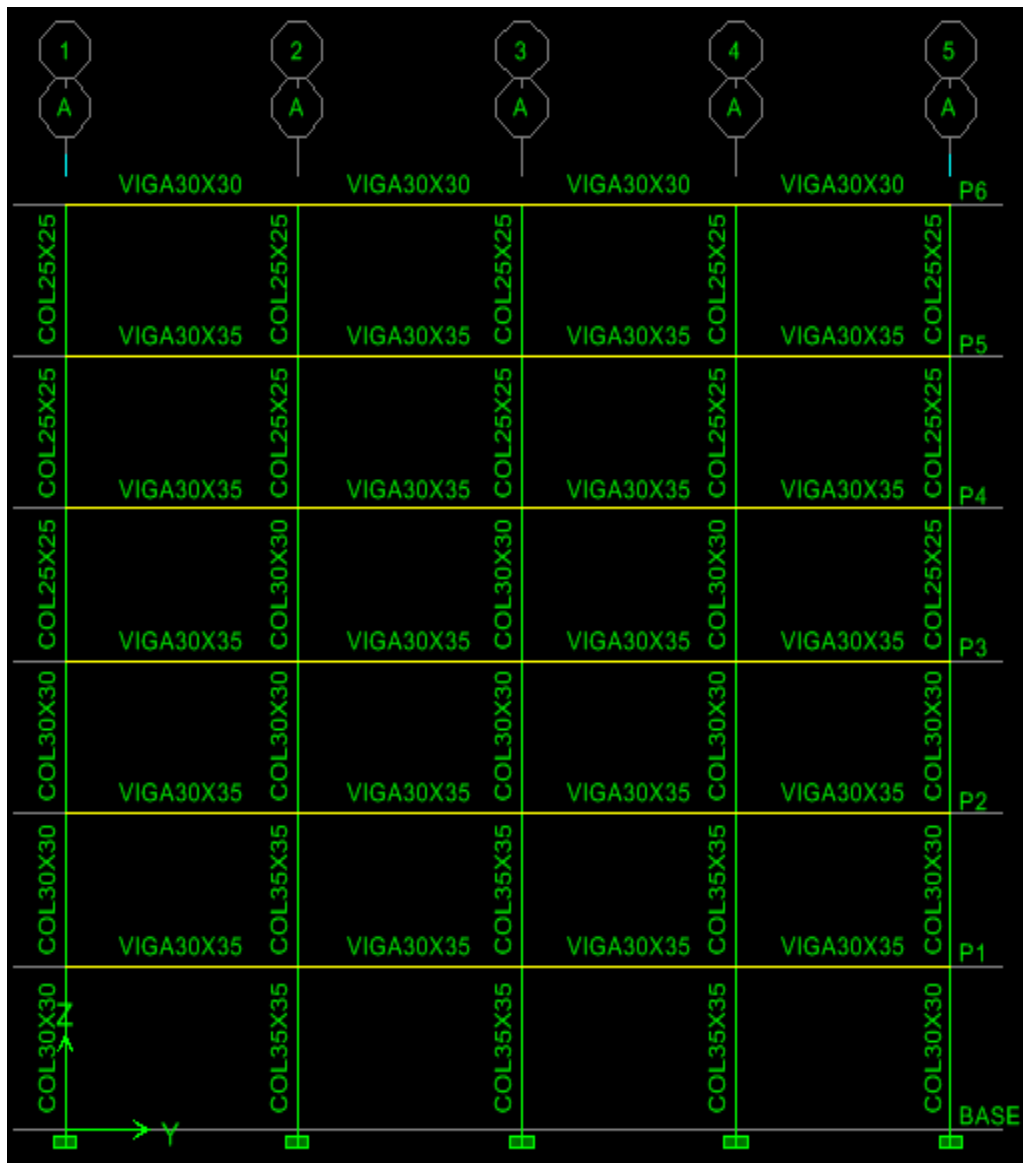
Modelo estructural con las secciones definidas Edifi 6 Pisos
